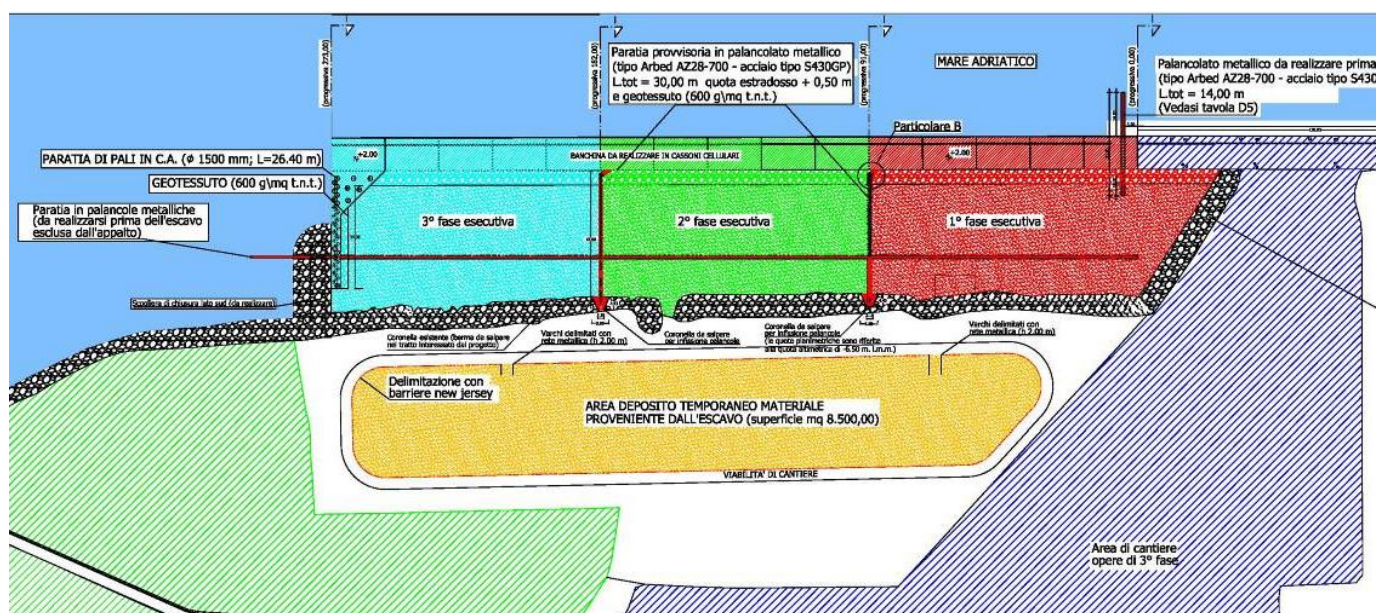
Dettaglio Tav. C4 – Planimetria fasi esecutive intervento di escavo
